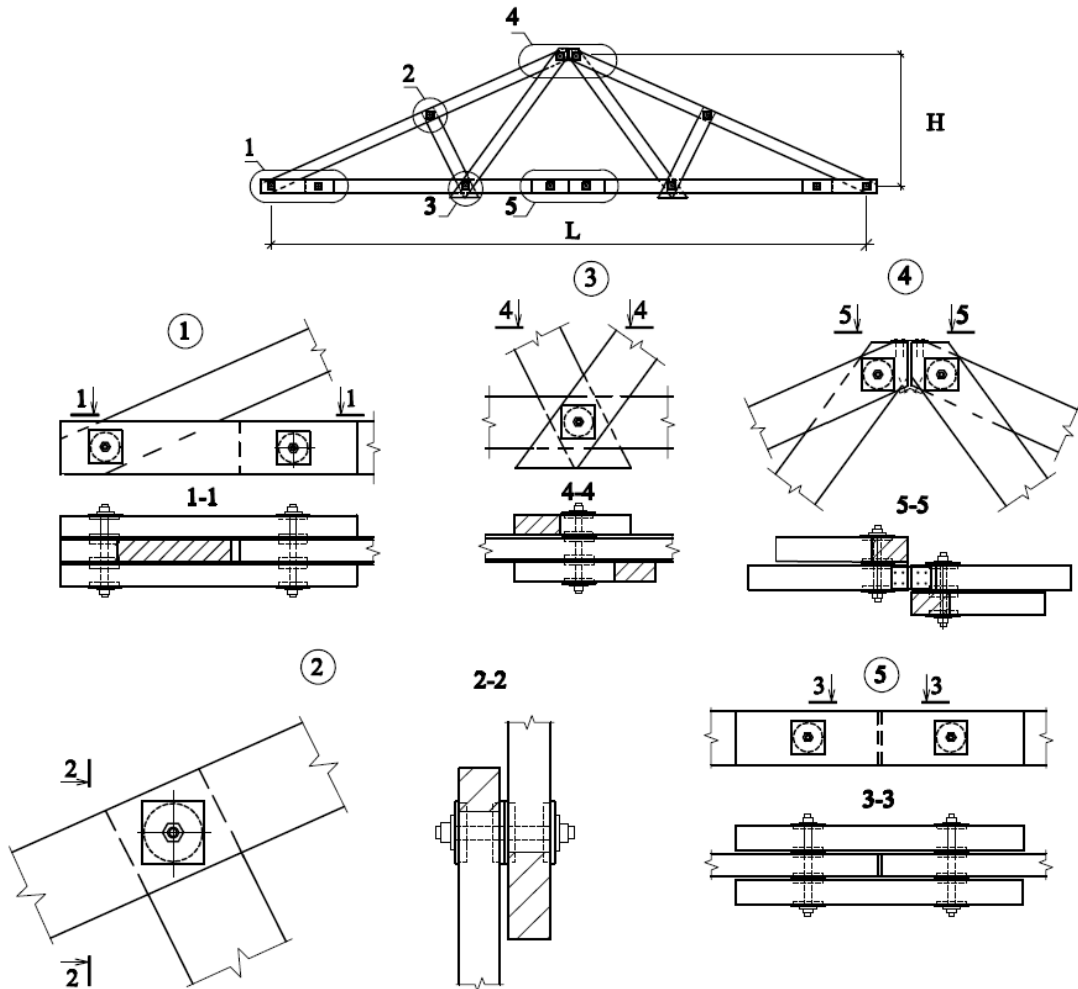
Конструктивное решение треугольной 4-панельной фермы и ее узлов:
